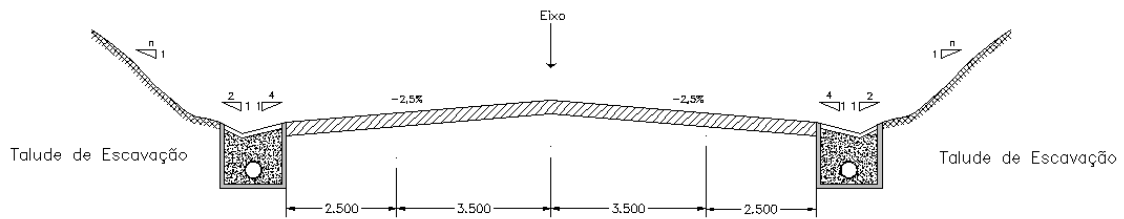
Perfil Transversal tipo em alinhamento reto – PK 0+600,000.
